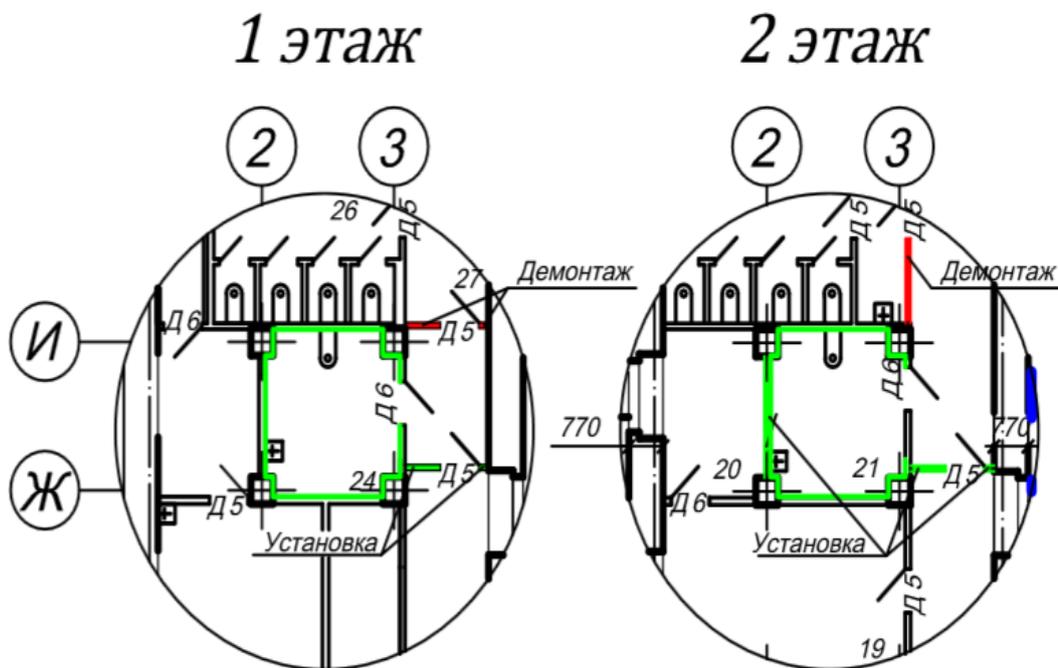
Фрагменты чертежей планов с универсальными уборными
